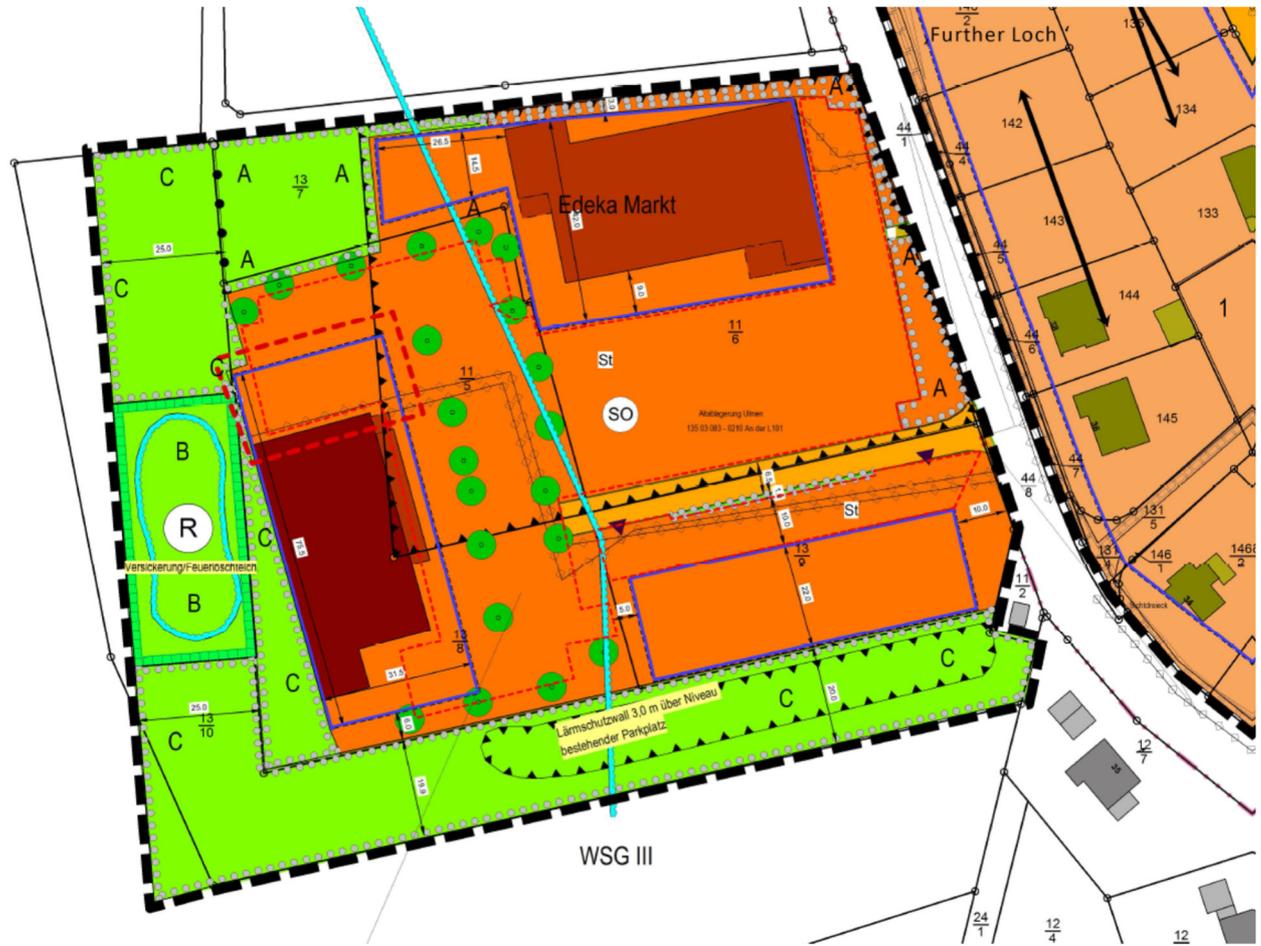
Bebauungsplan 'An der Reimertseiche' in der Fassung der 4. Änderung
